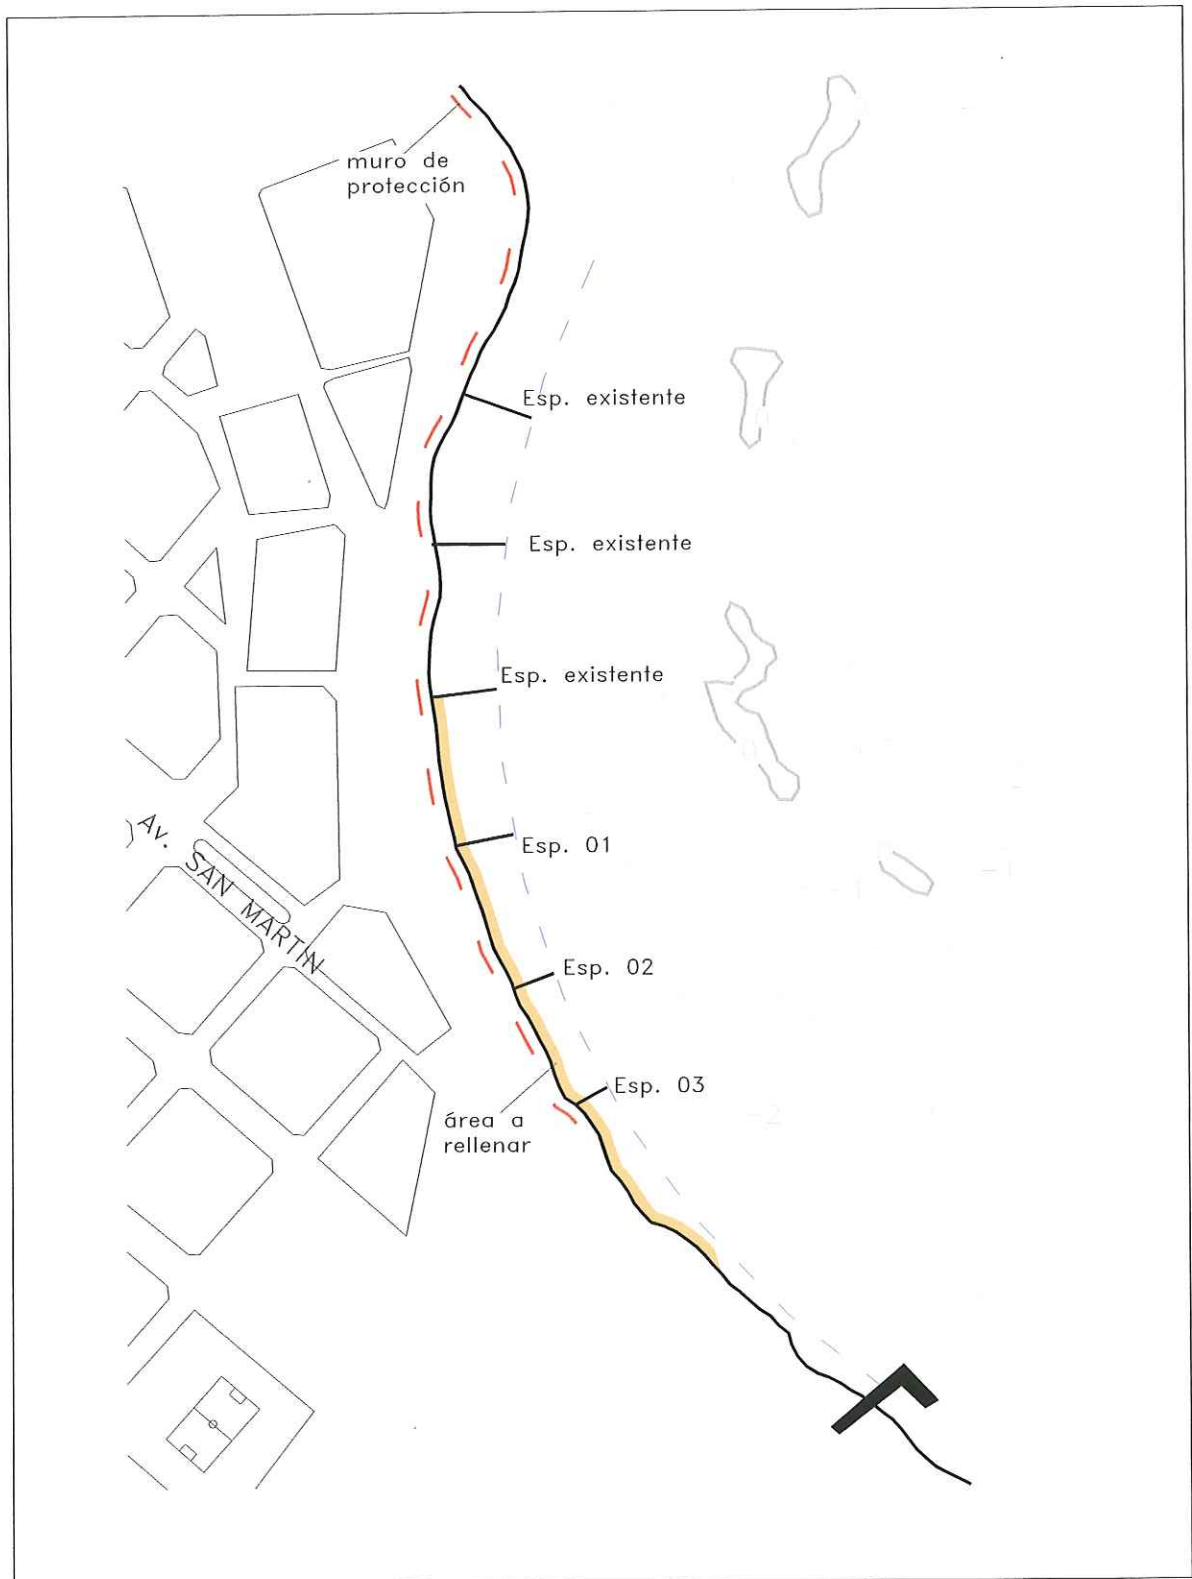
Espigones Tramo 1 – Vista en planta
